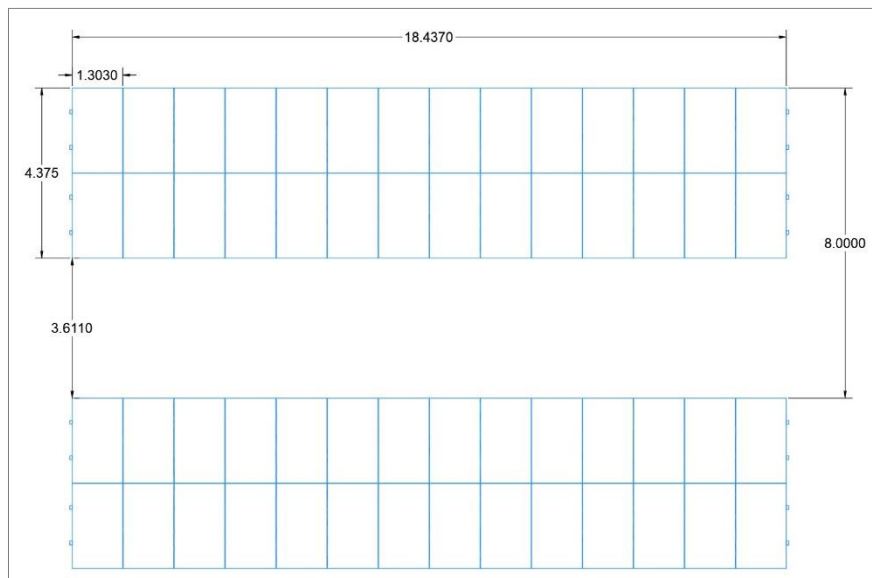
Distanza tra le strutture fisse con inclinazione 23°
